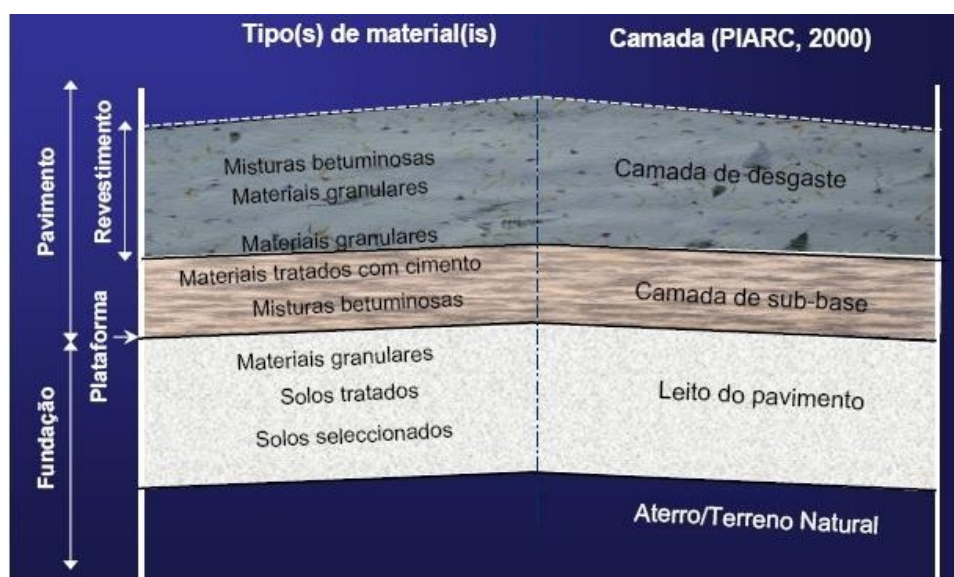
Constituição de um Pavimento Rígido (LNEC, 2005)
